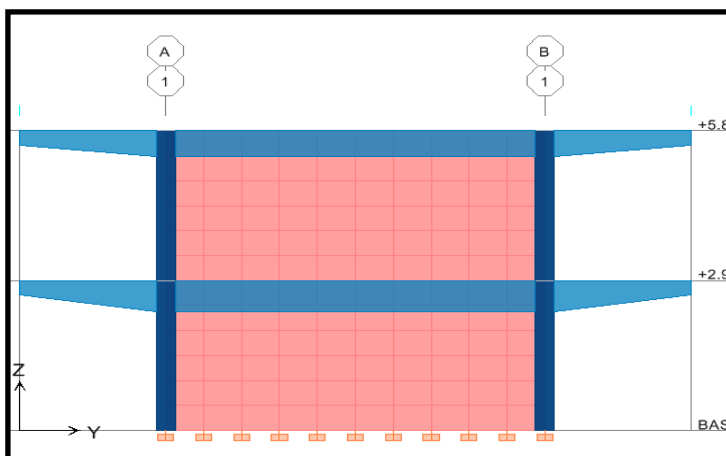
Alzado de la Propuesta de Reforzamiento en la dirección corta “y” de la edificación
